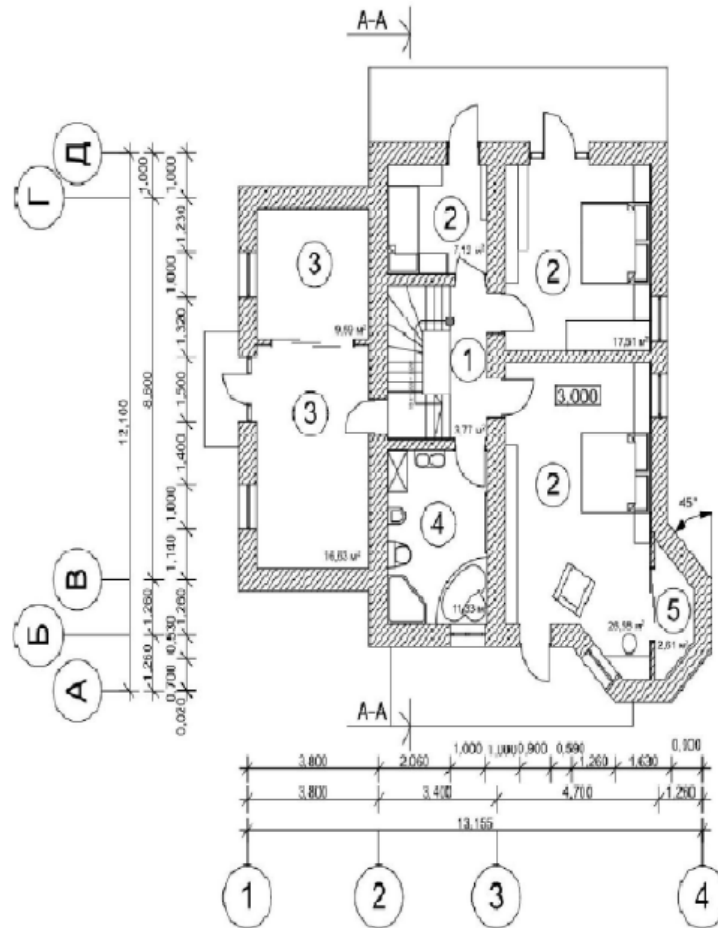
Індивідуальний 6-и кімнатний двоповерховий мансардний житловий будинок з гаражем. План 2-го поверху: 1 – хол; 2 – житлова кімната (спальня); 3 – житлова кімната (спальня); 4 – СВ (ванна, туалет); 5 –гардероб;
